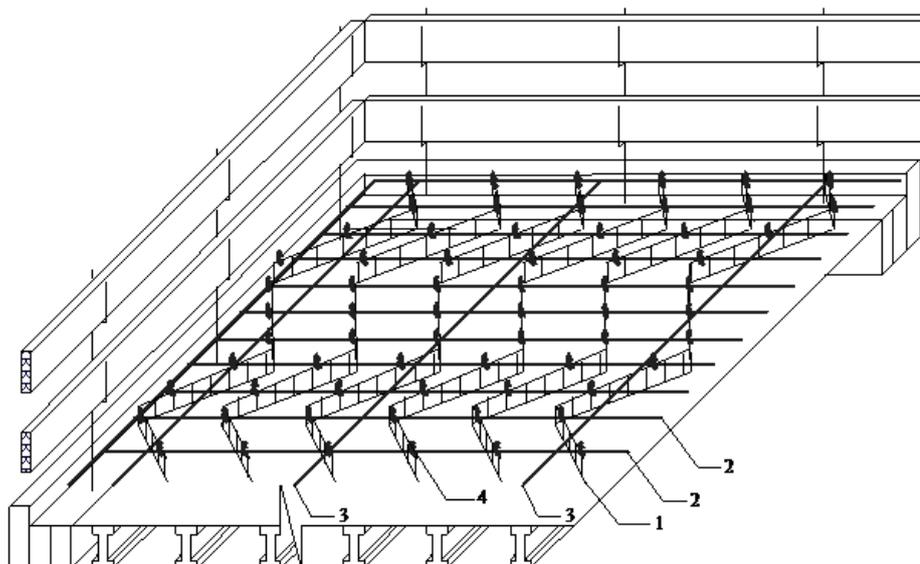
Устройство верхней арматурной сетки: 1 поддерживающие каркасы; 2 поперечные арматурные стержни верхней сетки, уложенные с проектным шагом; 3 продольные арматурные стержни, уложенные с увеличенным пролетом; 4 закрепление верхних поперечных стержней к поддерживающим каркасам с помощью вязальной проволоки
